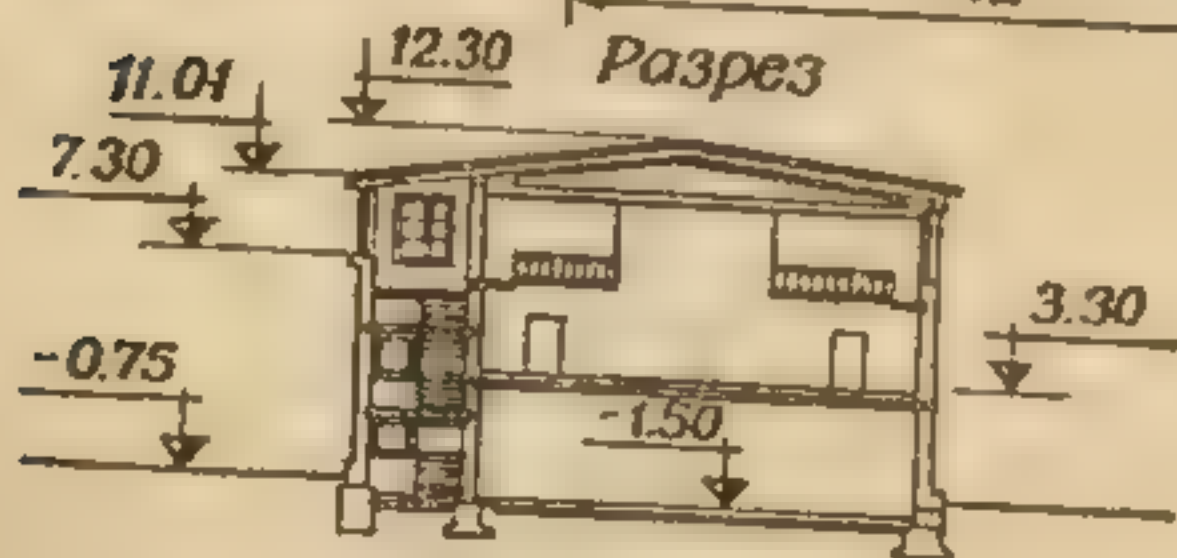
Спортивный корпус с двумя залами 36×18 м и 18×9 м:
